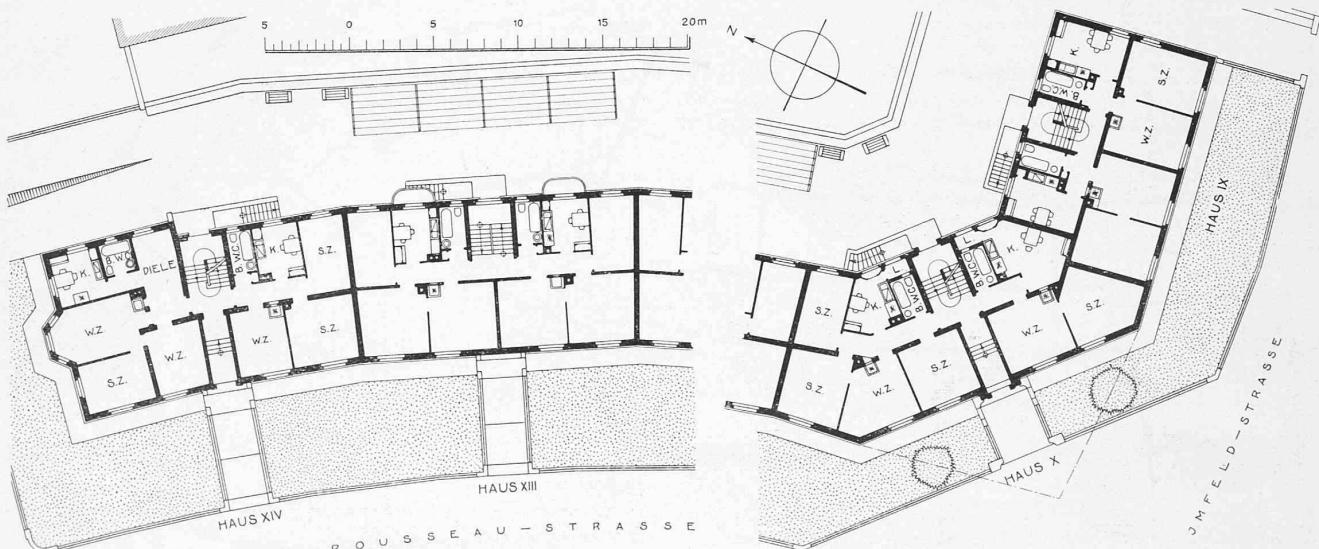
Grundrisse der Häuser IX bis XIV der Wohnkolonie Letten des eidgen. Personals, an der Rousseaustrasse in Zürich. — Masstab 1:400.
